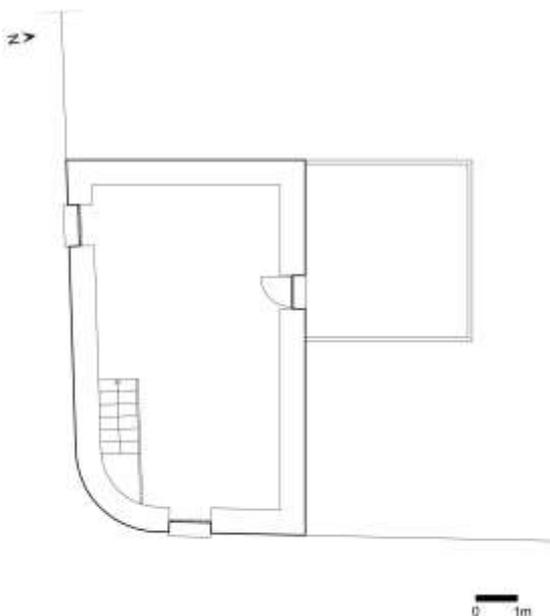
Planta do sótão. Espaço amplo. (Ilustração nossa, 2021)
